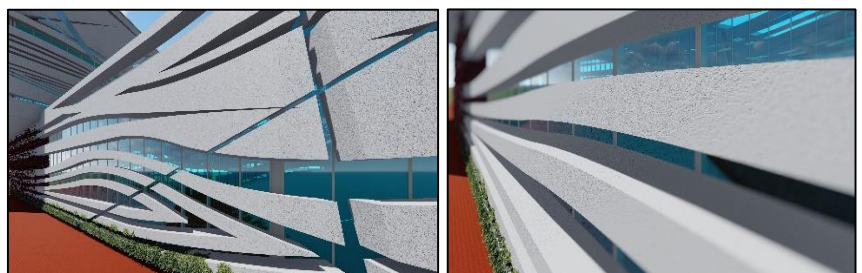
Brises soleil horizontaux dans le projet Source : Auteur
